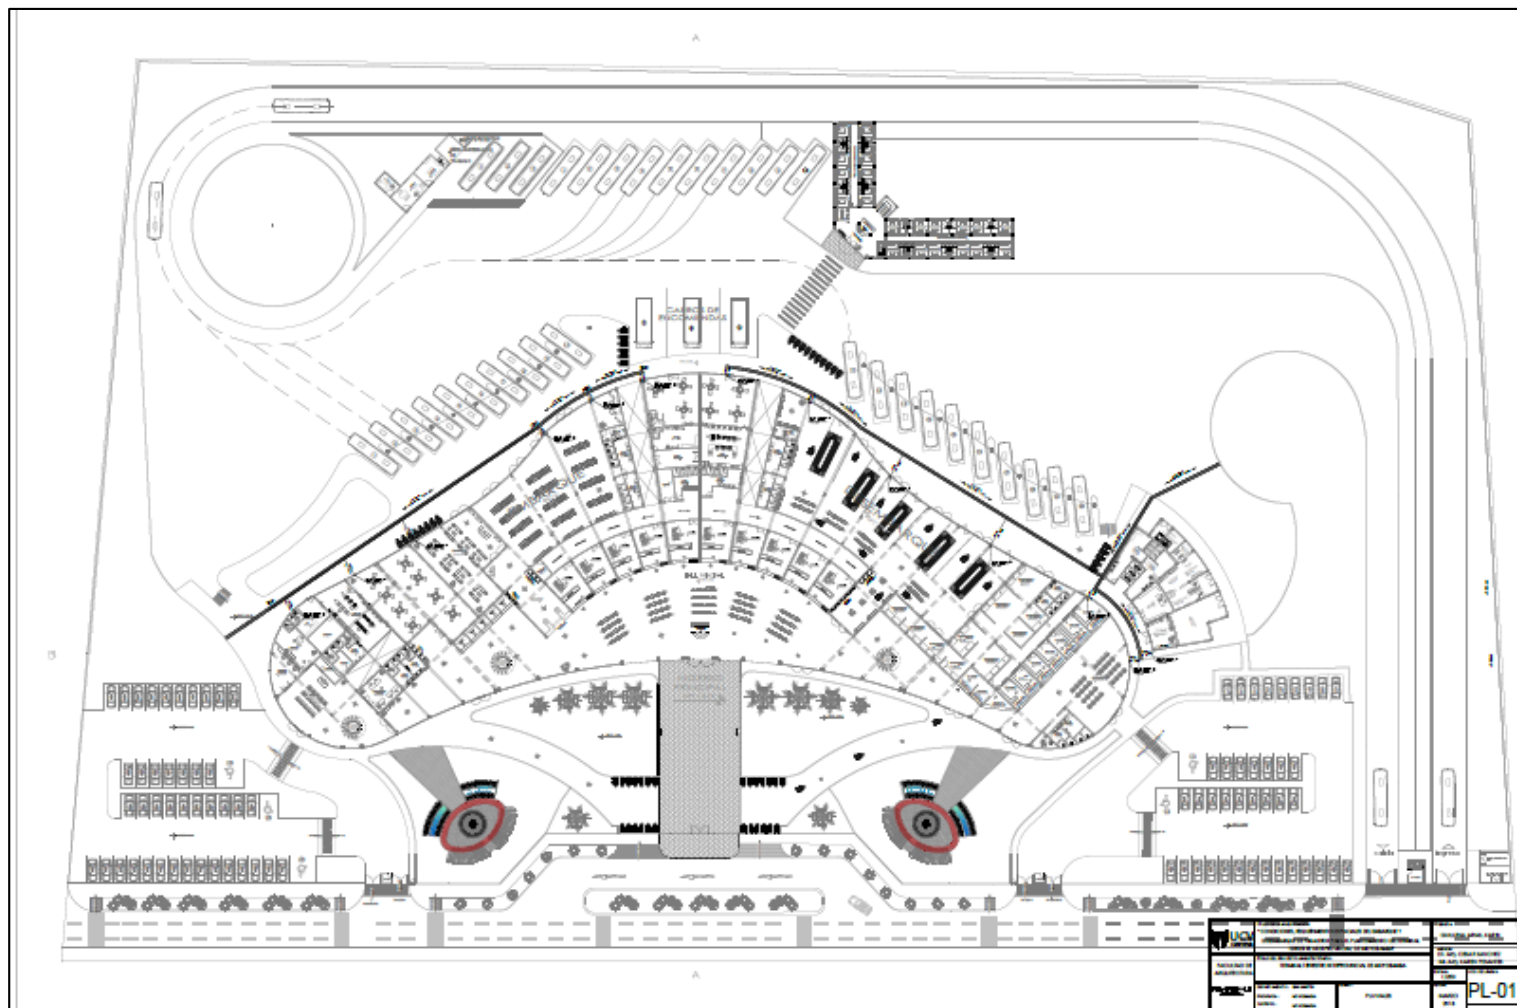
Plano desagüe pluvial, Fuente: Elaboración propia.
